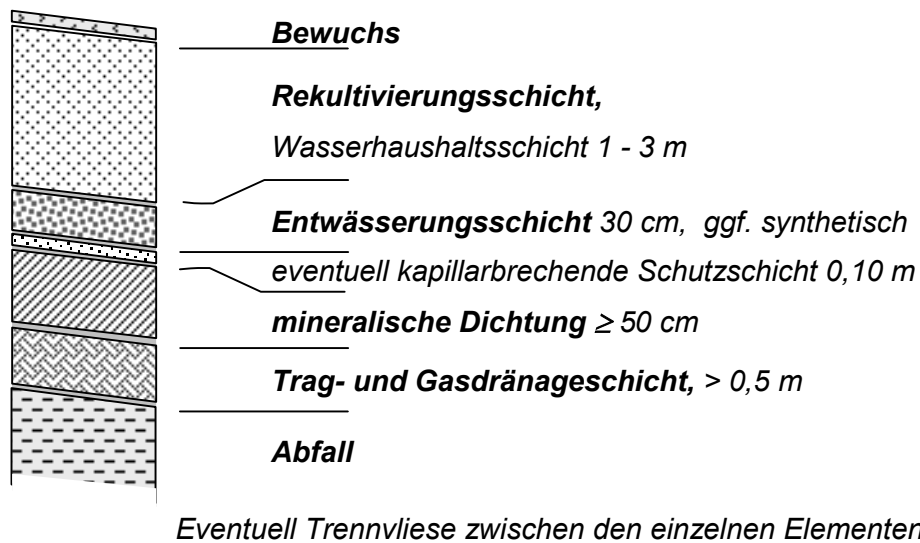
Prinzipschnitt zum Systemaufbau einer mineralischen Oberflächenabdichtung
